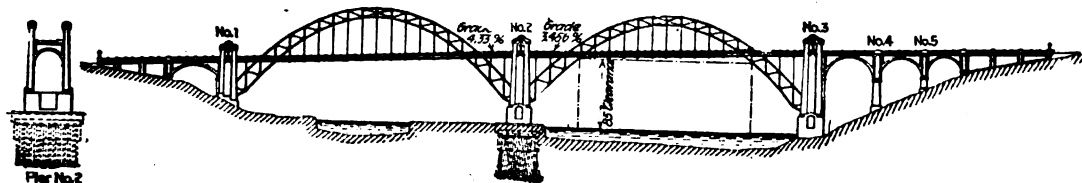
Vista del ponte secondo il progetto abbandonato
